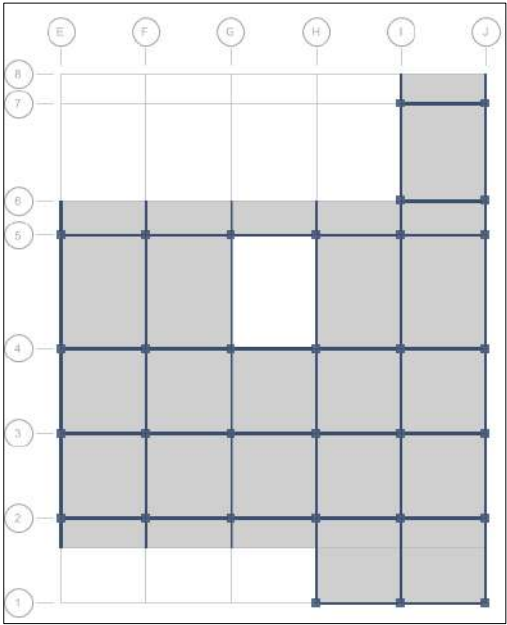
Planta Estructural N+3.61 Estructura 4.2 Torre Oriental
